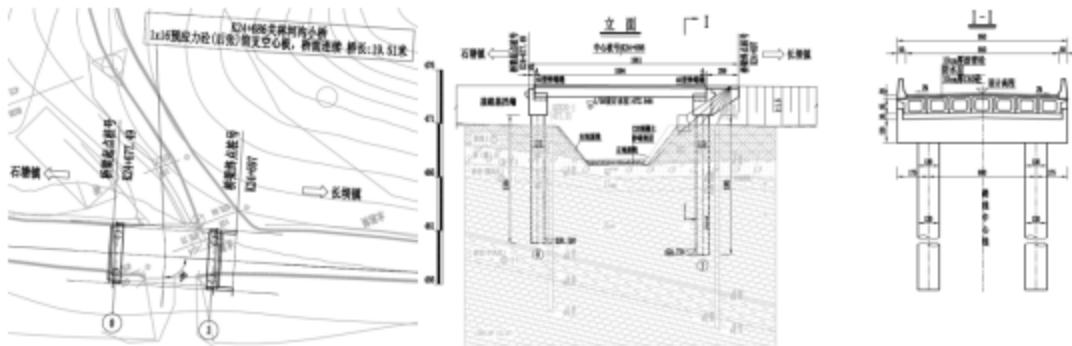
K24+686关林河沟小桥桥位、桥型平面布置图
